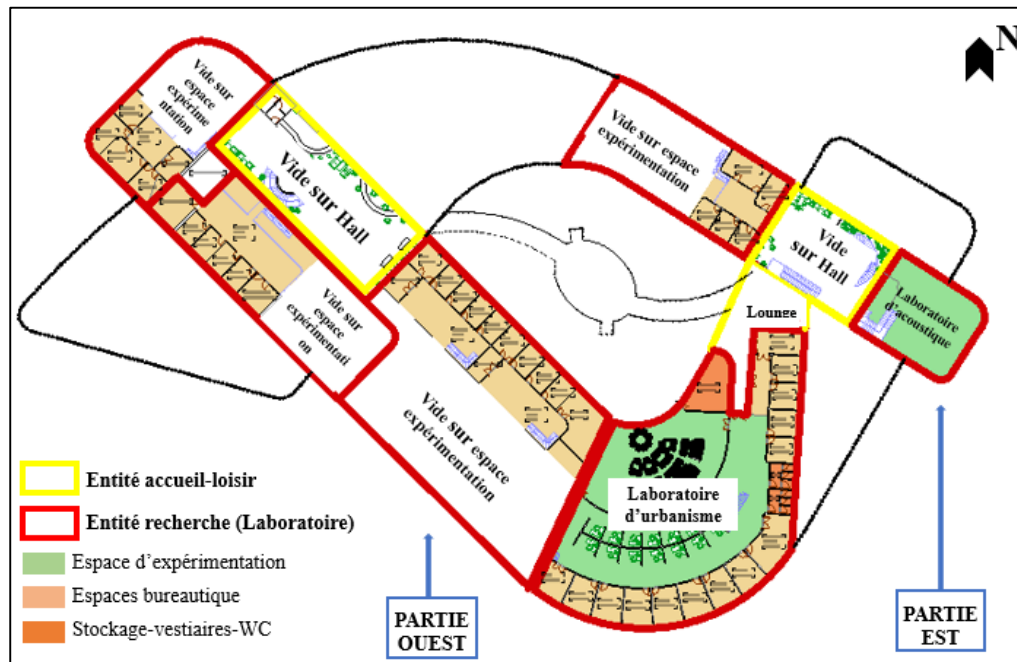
Plan 1^{er} Etage +09.00 Source : Auteur
